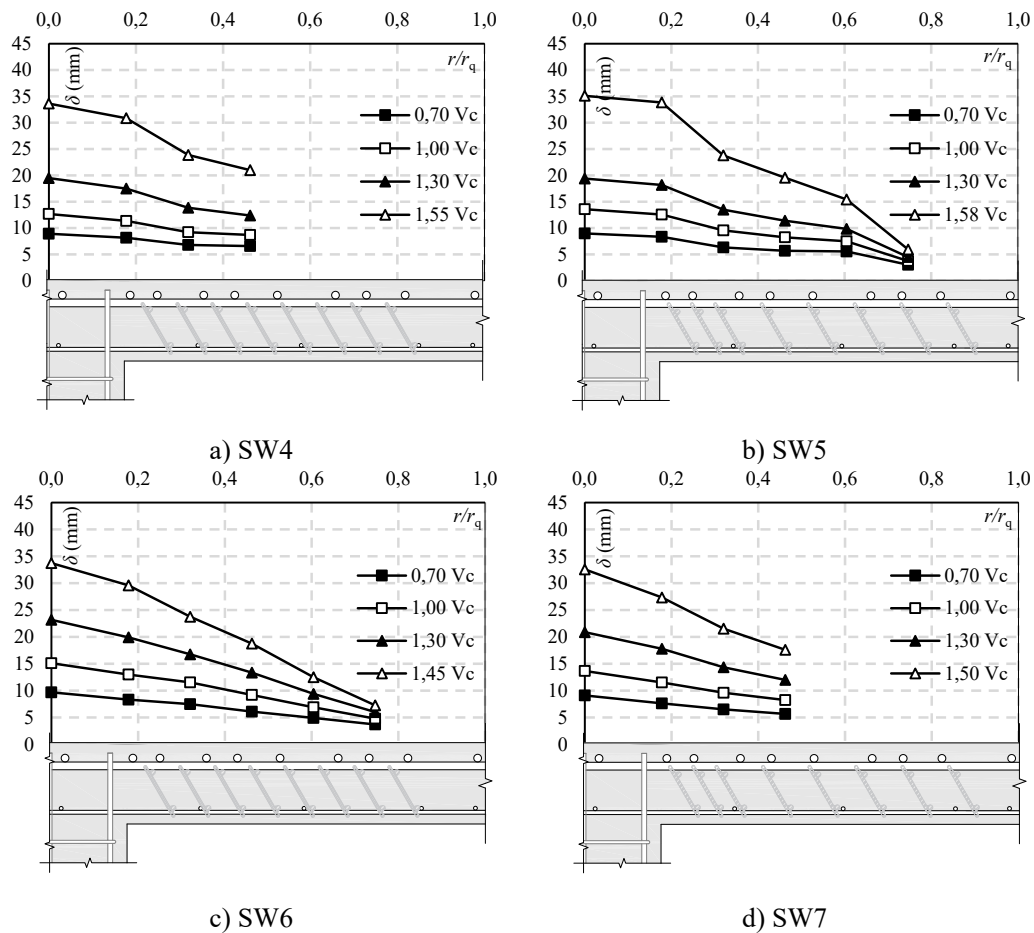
Perfil de deslocamento das lajes ensaiadas (continuação).
